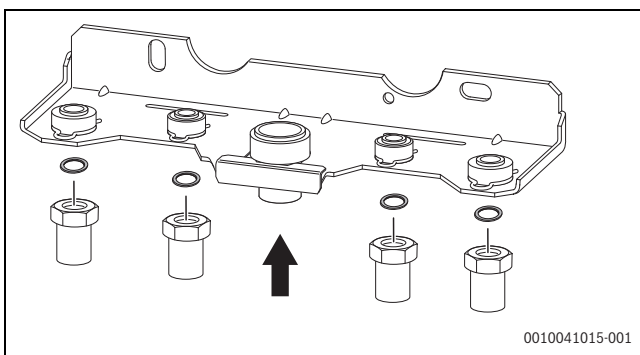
Rohre mit Dichtungen an Montageanschlussplatte montieren
